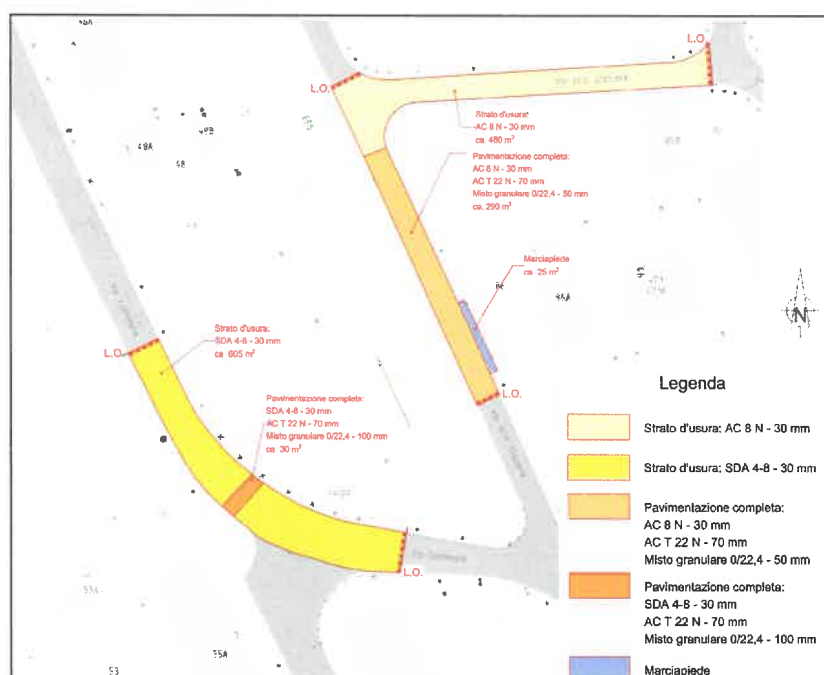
Estratto planimetrico Interventi stradali - piano 206 interventi stradali
